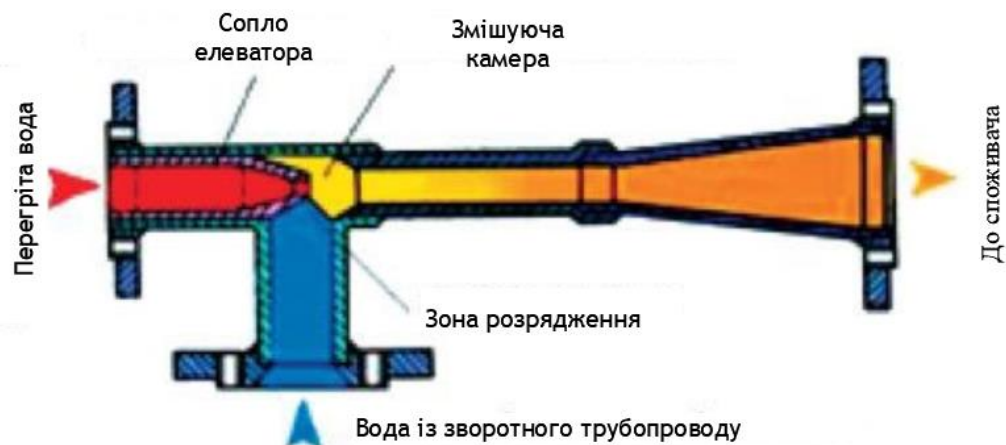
Принципова схема конструкції елеваторного вузла
